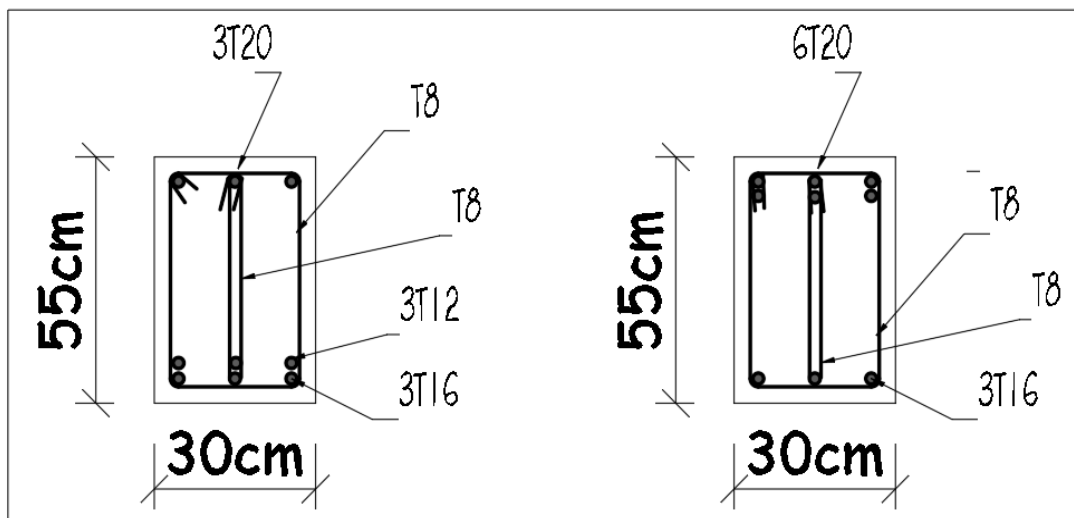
Ferraillage de la poutre principale du 6^{ème} au 9^{ème}
